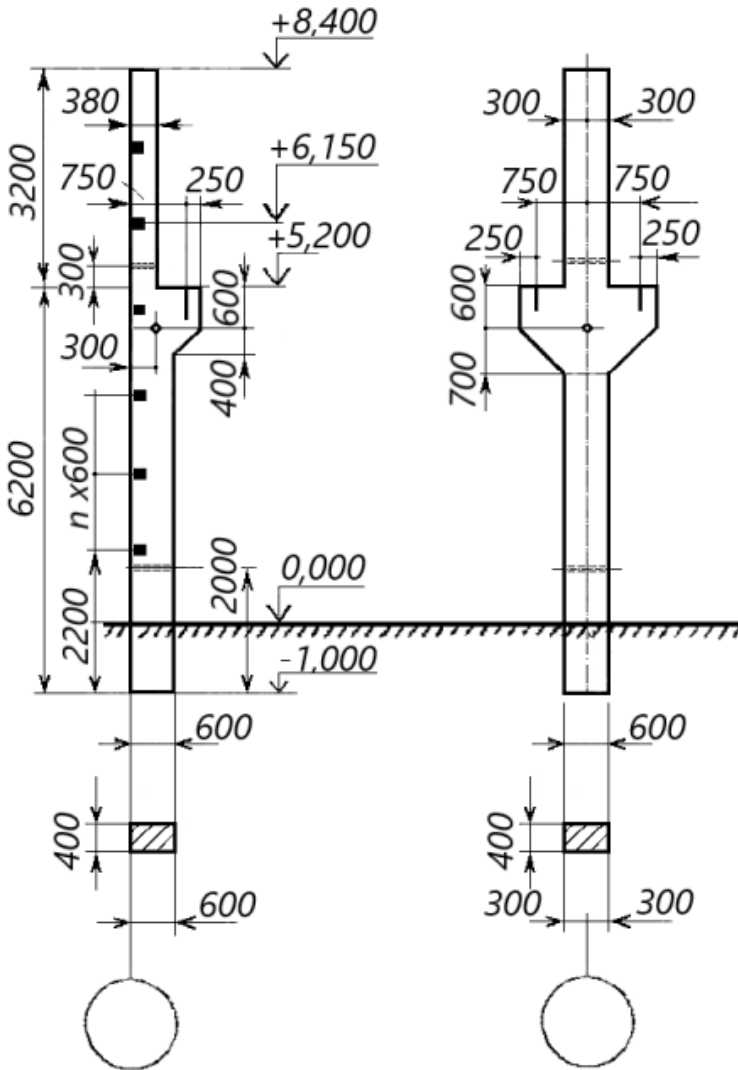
Типові колони для будівель висотою 8,4 м, з кранами вантажністю 100 кН, прольотами 18 м або 24 м, з кроком колон 6 м
